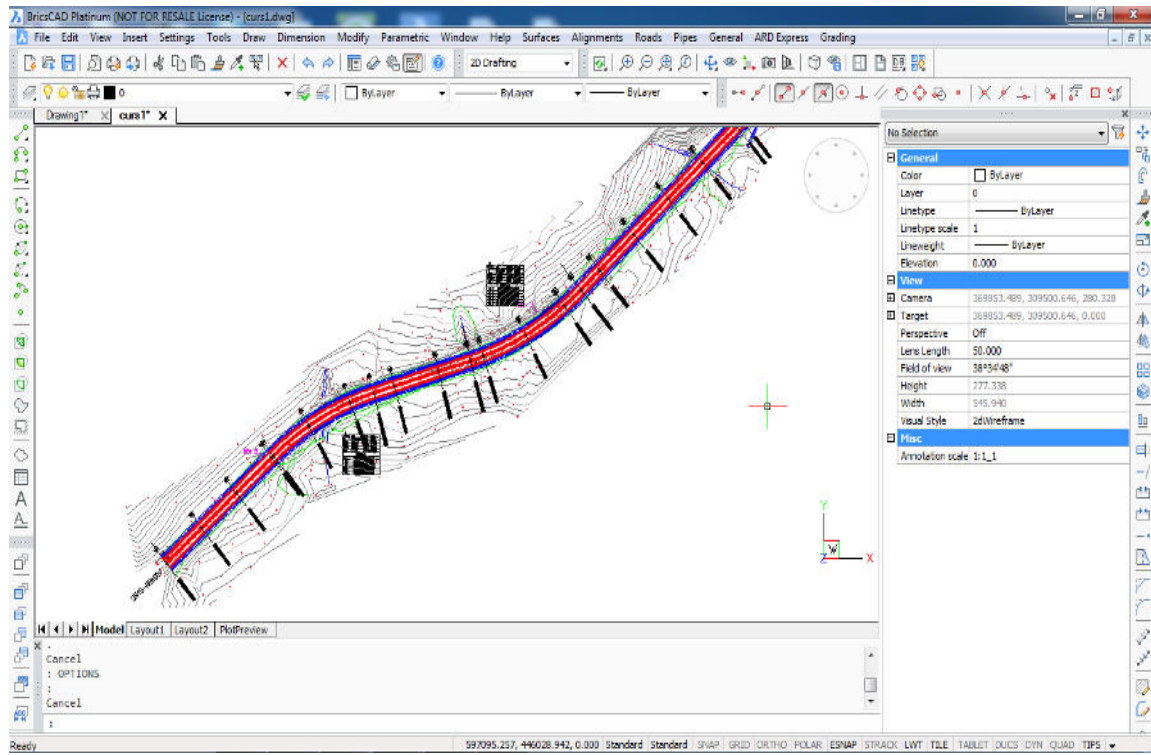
Suprafața de teren cu axul în plan și planul de situație proiectat pentru o lungime prestabilită de drum
